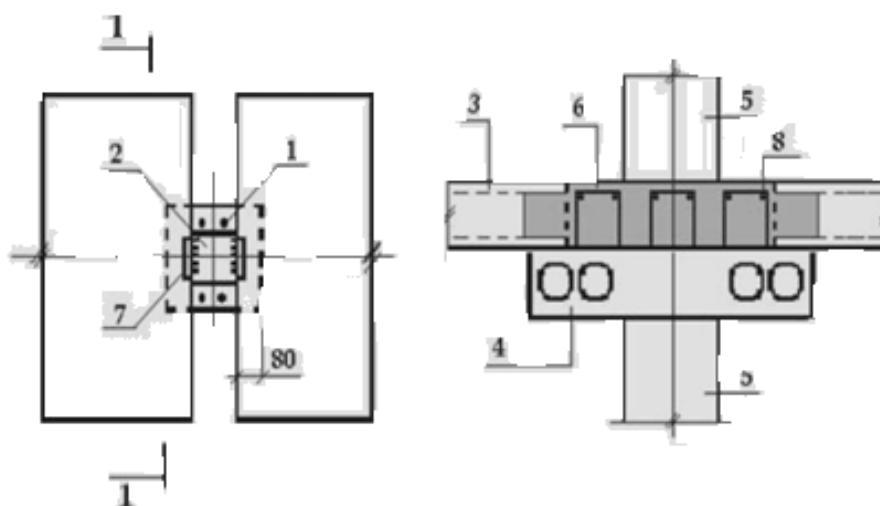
Стык колонны с плитным ригелем и плитами перекрытия: 1 – выпуски арматуры колонны; 2 – закладная деталь колонны; 3 – пустотная плита; 4 – сборный плитный ригель; 5 – колонна; 6 – бетон замоноличивания; 7 – закладная деталь плитного ригеля; 8 – надпорная арматура плитного ригеля
